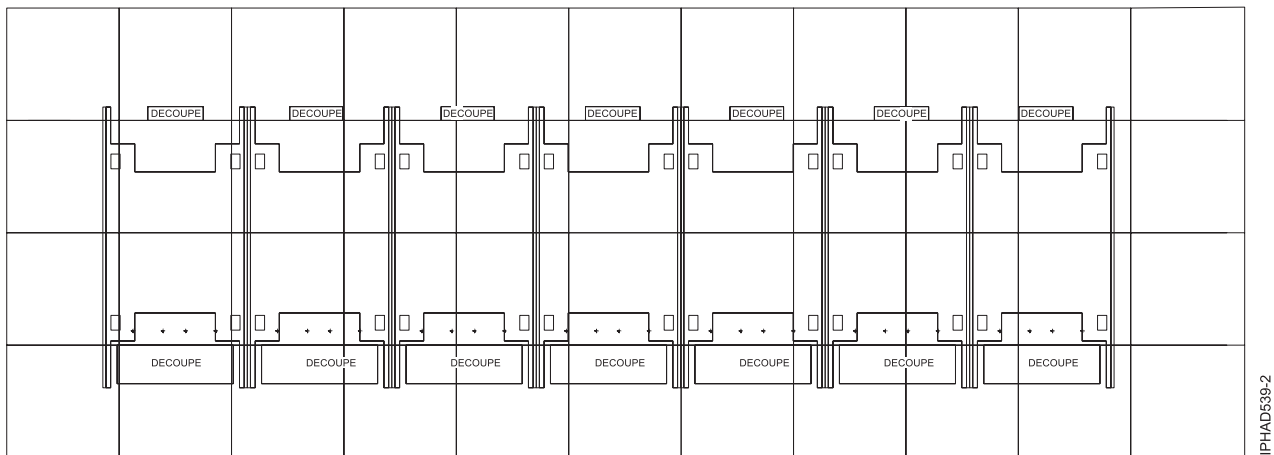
Découpe de dalle de plancher de 600 mm avec plusieurs cadres (premier cadre centré sur la dalle de plancher)
